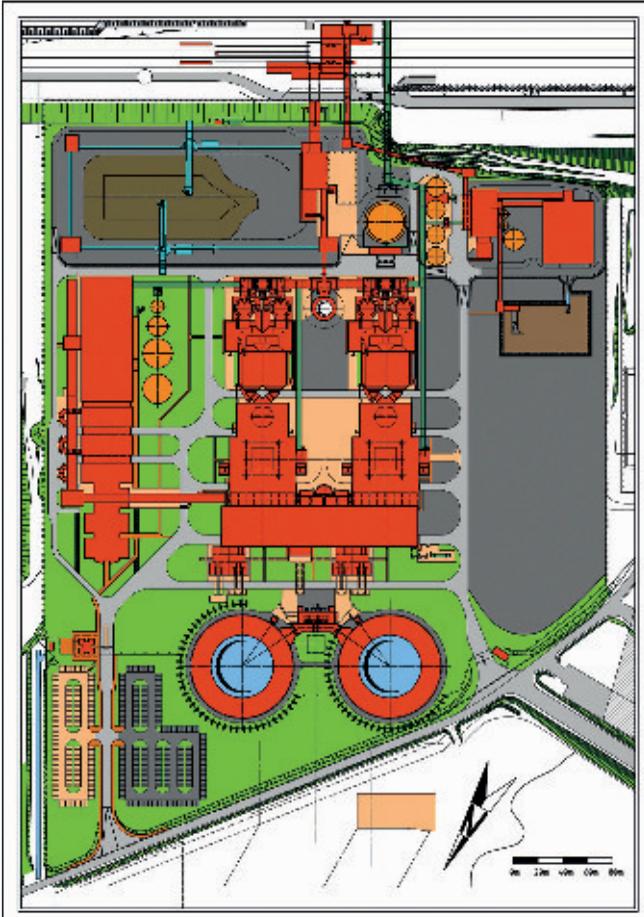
Lageplan des Kraftwerkes Schkopau (Nord-Südausrichtung)
